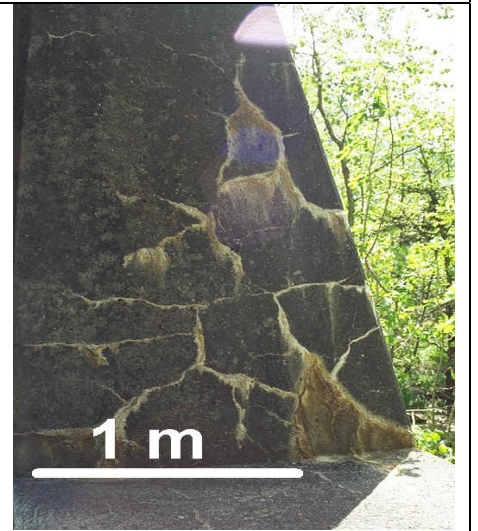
Entrée de tunnel: fissuration grossière (écartement des fissures de l'ordre du dm) avec efflorescences claires et des traces de rouille (brun-rouge) suite à la corrosion des armatures, *dégradation forte
